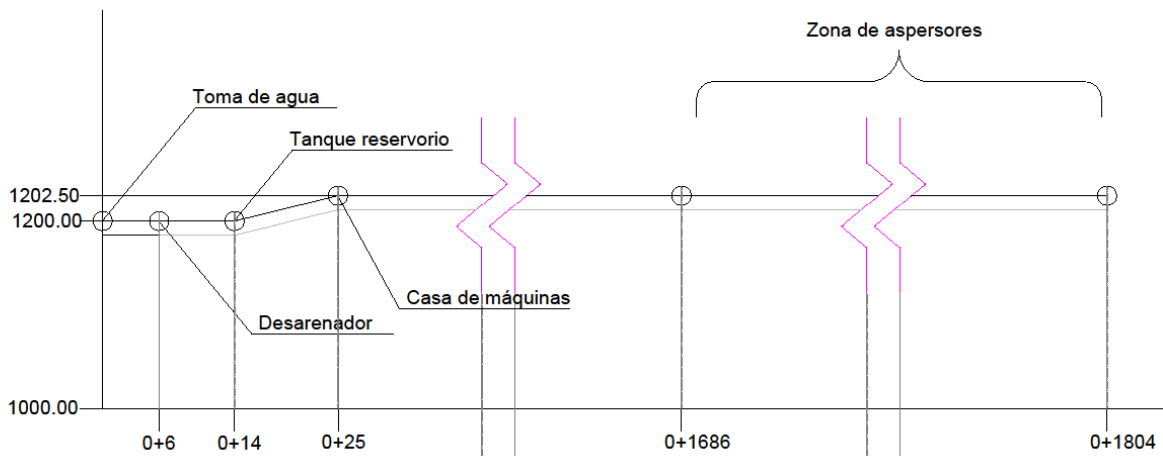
Detalle constructivo de alturas y longitudes del sistema de riego. Fuente: Autor.
